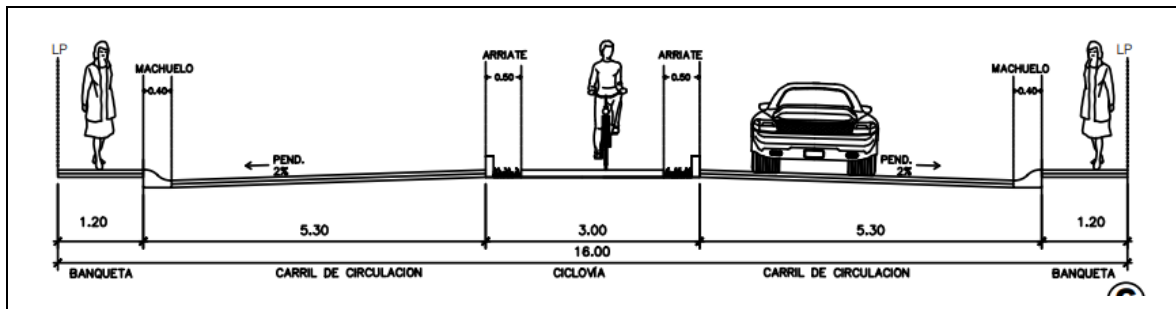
Sección vial en vialidades colectoras privadas tipo "B"
